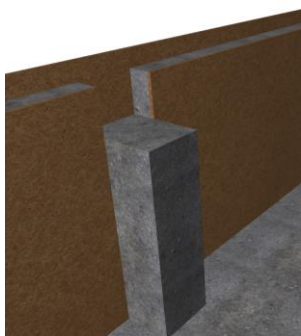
Vylitá základová deska s nachystanou výztuží do stěn
